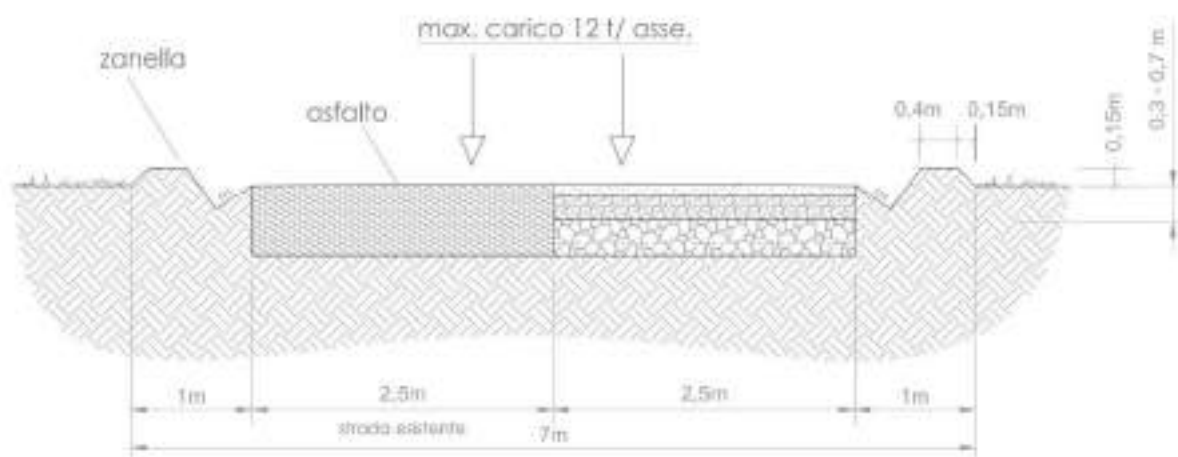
Sezione stradale tipo nel caso di allargamento della sede stradale esistente
